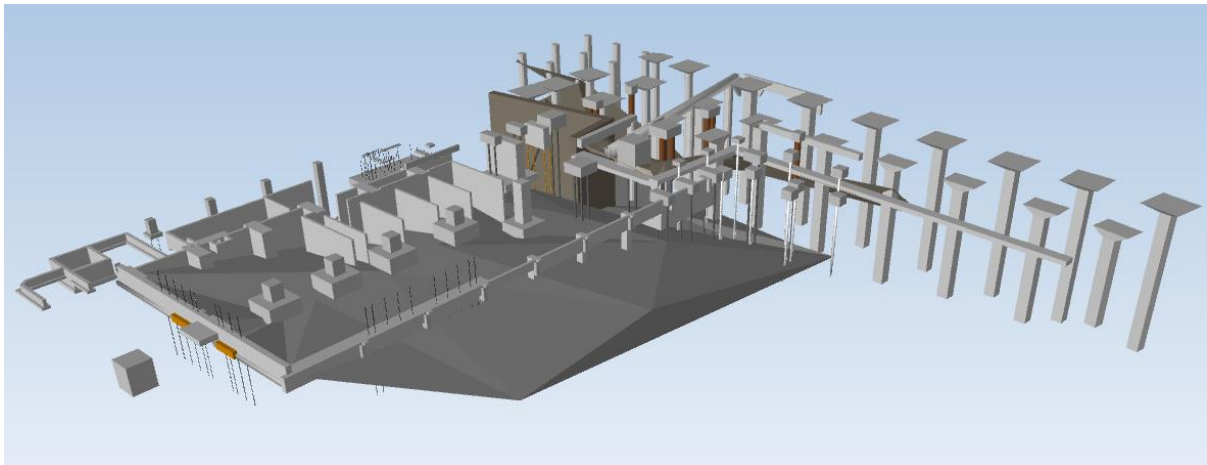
Plan 0 til og med Plan 2 Synchro 4D
